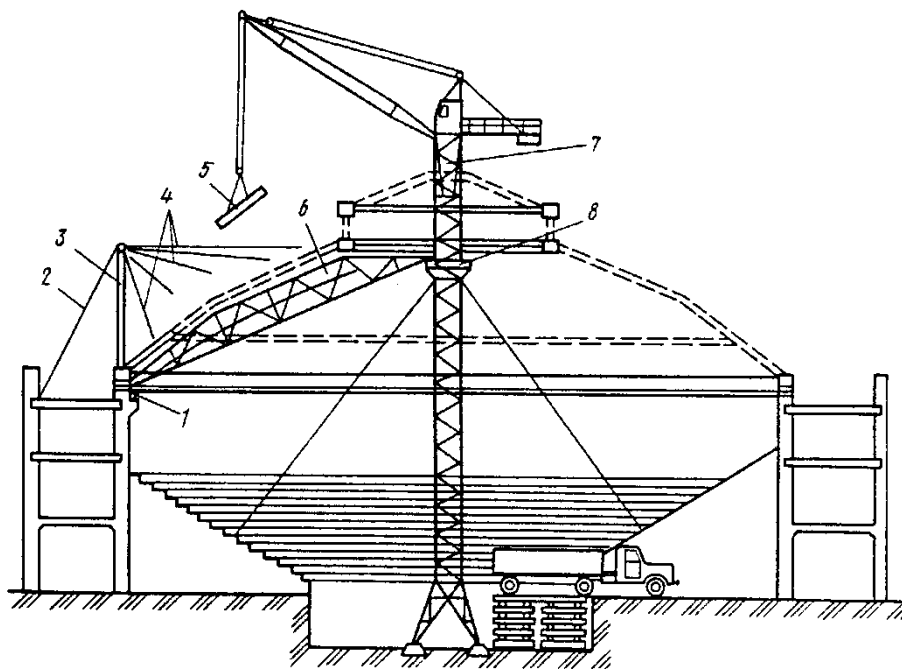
Схема монтажу купольного покриття з використанням як опори вежі крана: 1 – кільцевий рейковий шлях; 2 – канатні розчалювання; 3 – стояк; 4 – тимчасові підвіски; 5 – збірні панелі; 6 – ферма-шаблон (кондуктор); 7 – баштовий кран; 8 – опорна площадка
